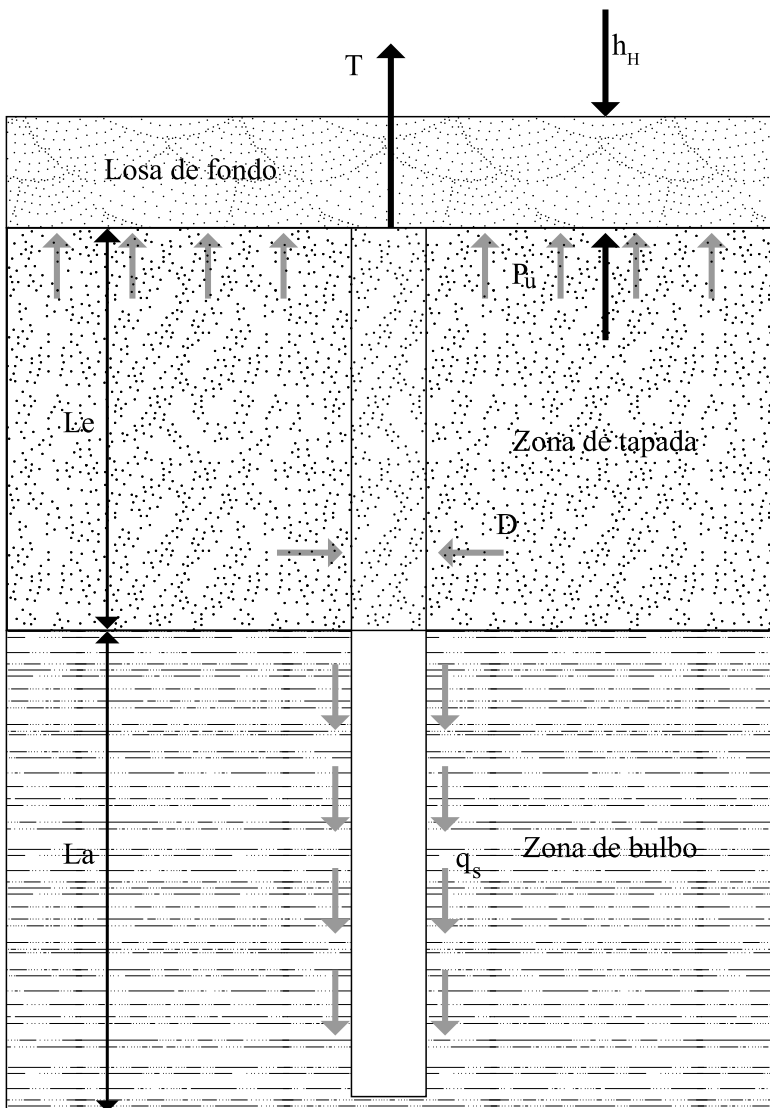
ESQUEMA DE CÁLCULO ALTERNATIVO DE ANCLAJE PARA LOSA DE SUBPRESIÓN
